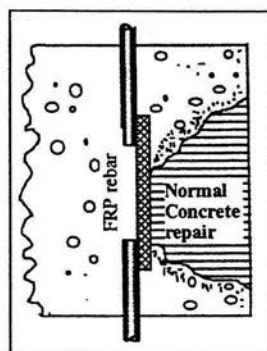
Reparación con concreto normal y fibras de plástico reforzado.
